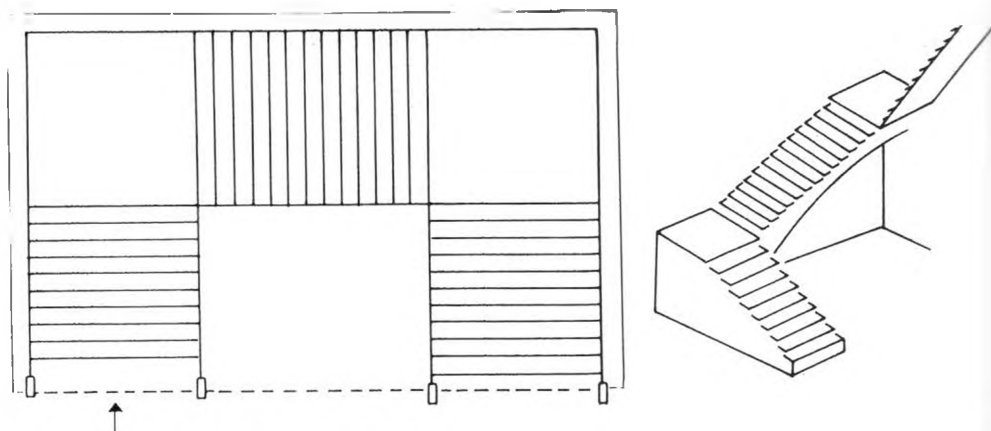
Planta y alzado de la escalera interior del Palacio de los Guzmanes de León.
